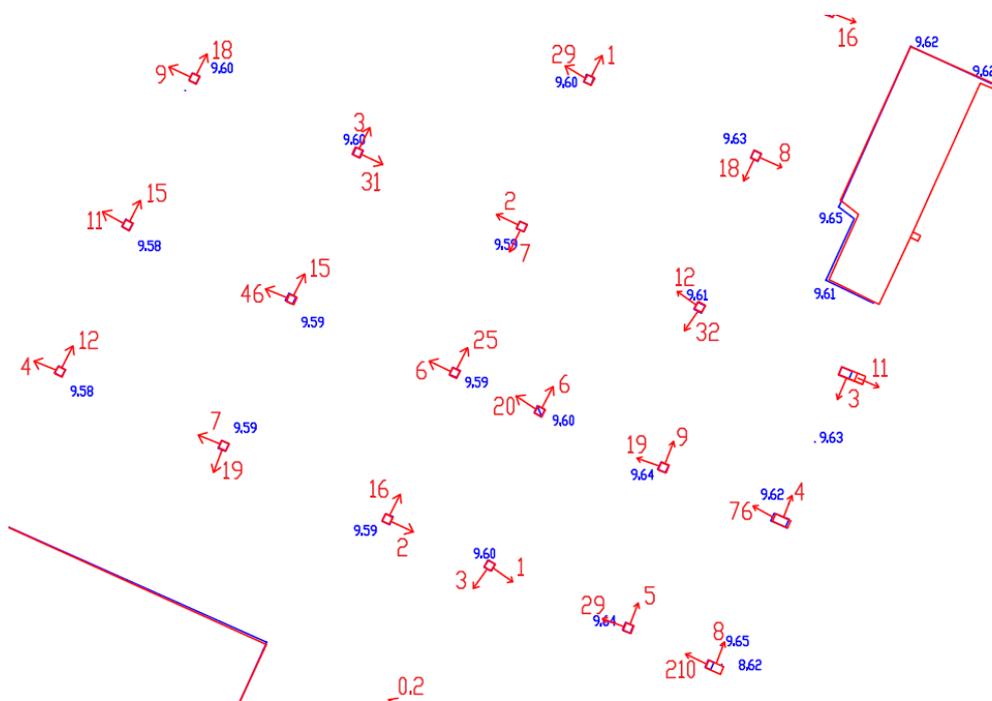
Фрагмент исполнительной схемы смещения колонн 2 этажа в верхнем сечении относительно низа колонн 1 этажа
